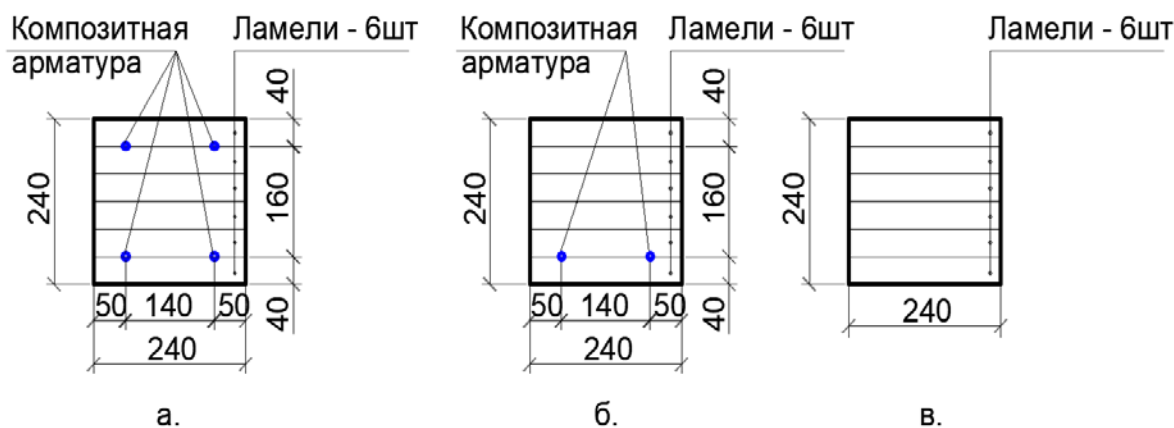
а) клееная деревянная балка с армированием сжатой и растянутой зон; б) клееная деревянная балка с армированием растянутой зоны; в) клееная деревянная балка без армирования, мм
